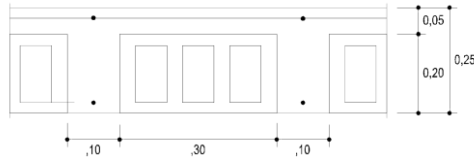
27 SECCIÓN DE VIGUETAS
